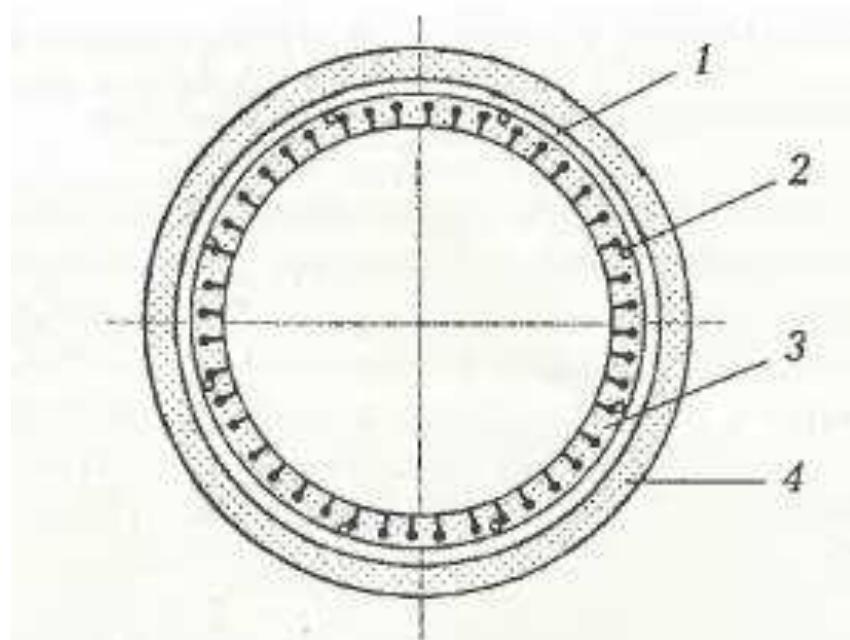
Полимержелезобетонная труба: 1 – спиральная арматура; 2 – продольная арматура; 3 – профилированная полимерная оболочка; 4 – бетонная стенка
